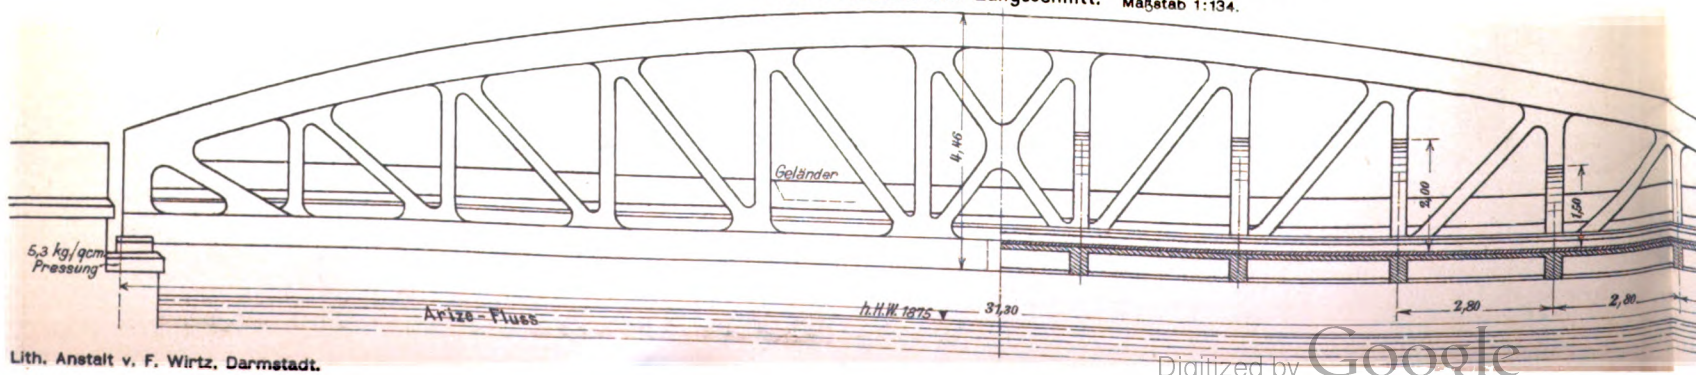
bis 9. Eisenbahn-Fachwerkbrücke aus Eisenbeton.
